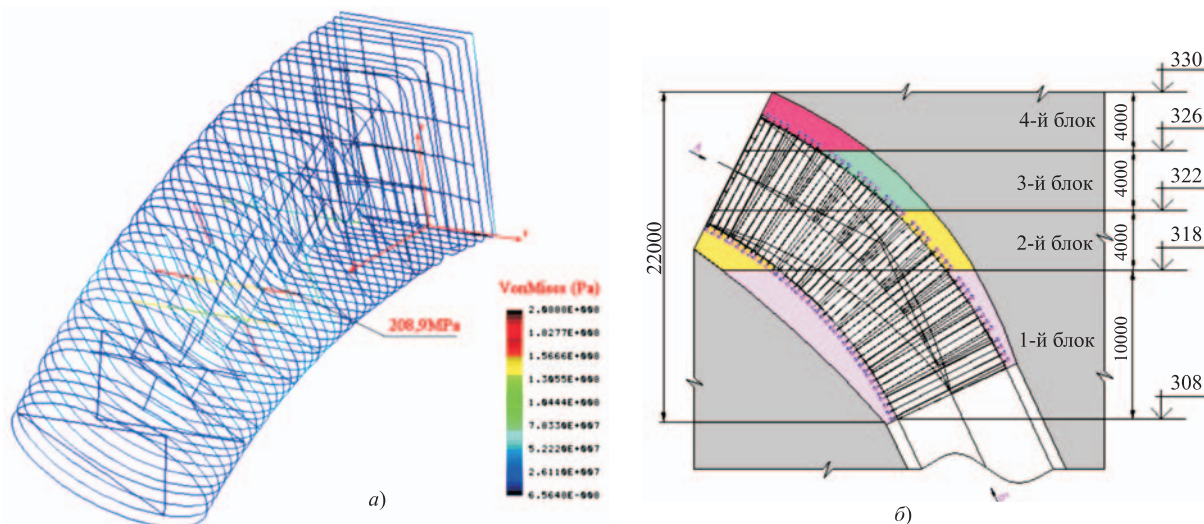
Распределение напряжений в конечных элементах облицовки переходной камеры — а; схема облицовки переходной камеры и разбивка на блоки бетонирования — б
